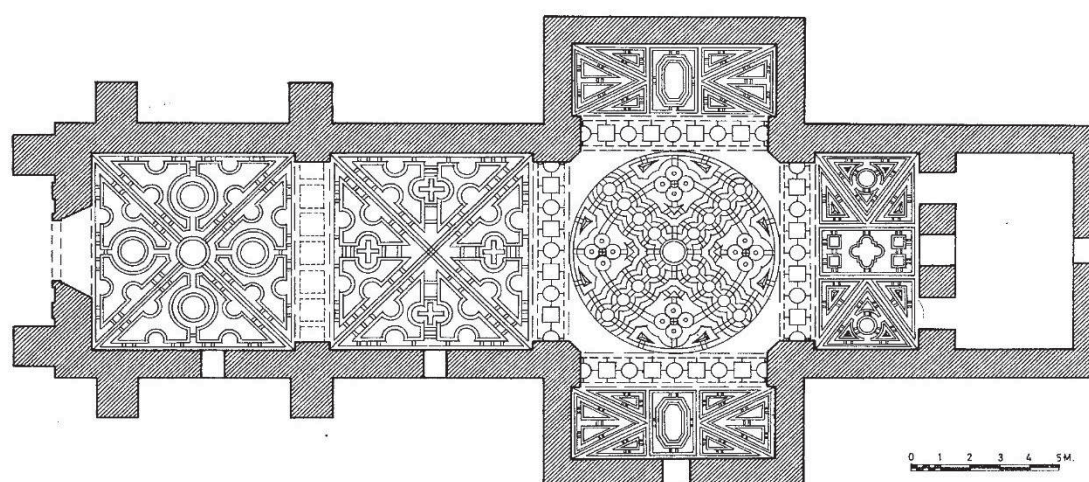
plano de la ermita de Pesquera de Duero (fuente: ZALAMA RODRIGUEZ, M. A., Ermitas y santuarios..., p. 113)
